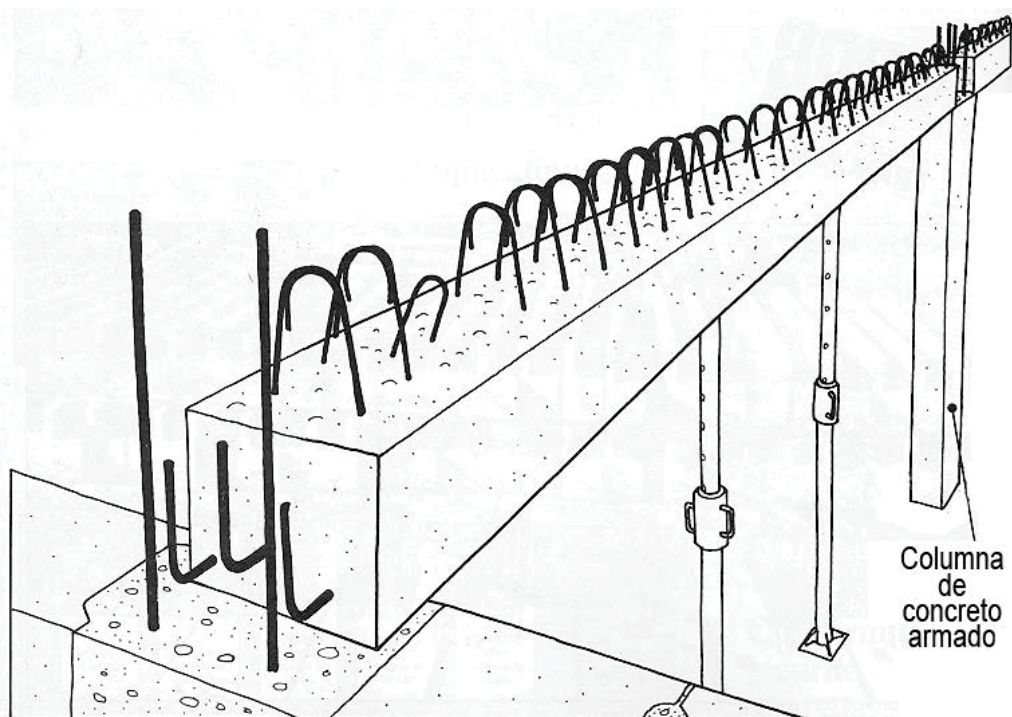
TRABES SEMIPREFABRICADAS CON ESTRIBOS EN ESPERA APOYADAS SOBRE MUROS Y/O COLUMNAS
